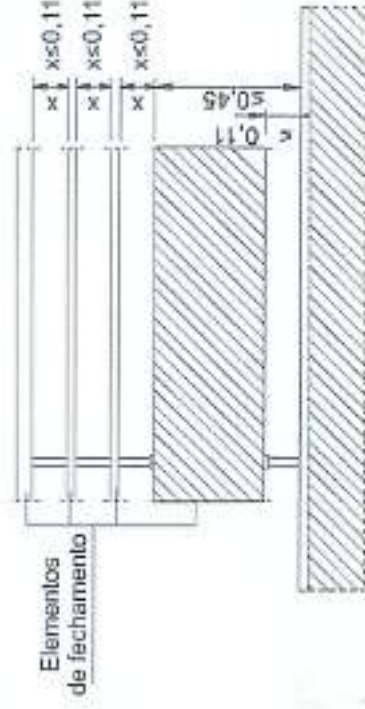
Espaçamento entre perfis horizontais (dimensões em metros)
